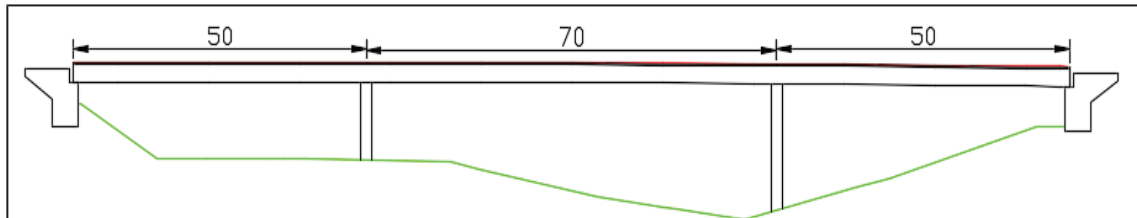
Coupe longitudinale de la variante pont mixte acier béton.
